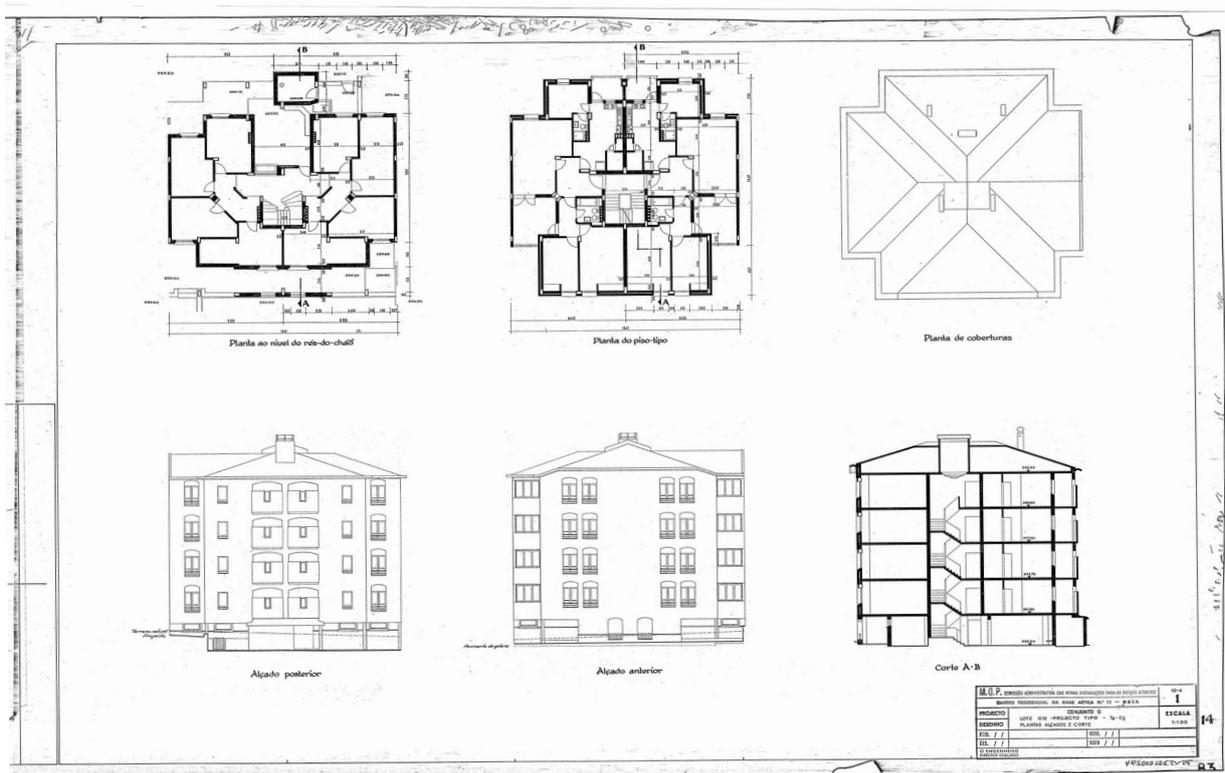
Projeto: lote G12, projecto tipo – T4 – C2, plantas, alçados e cortes
